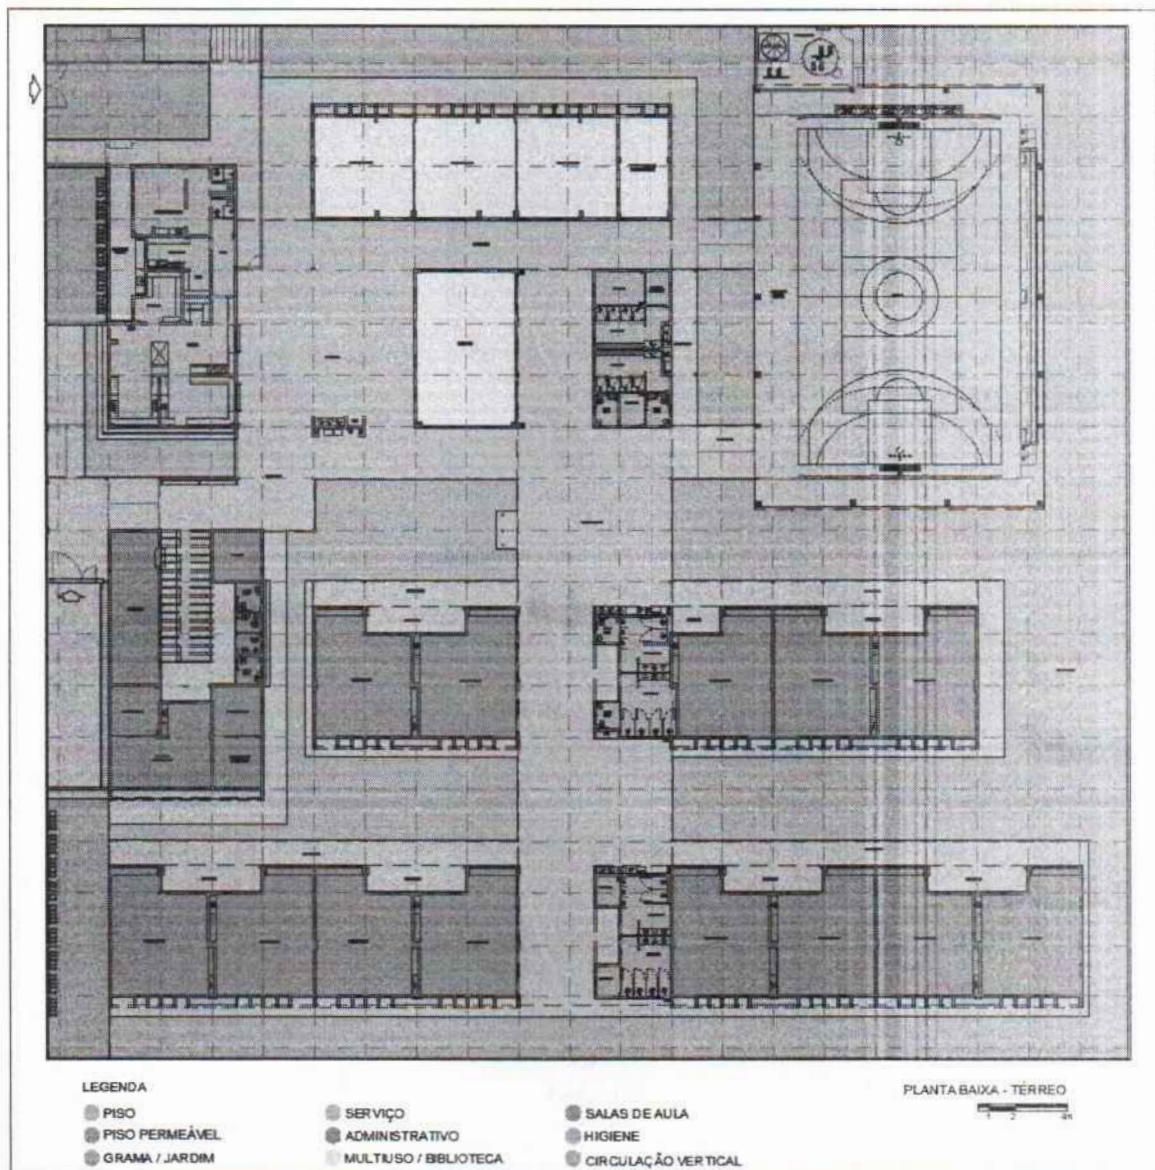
planta baixa de implantação dos blocos – Escola 13 Salas - Térreo
